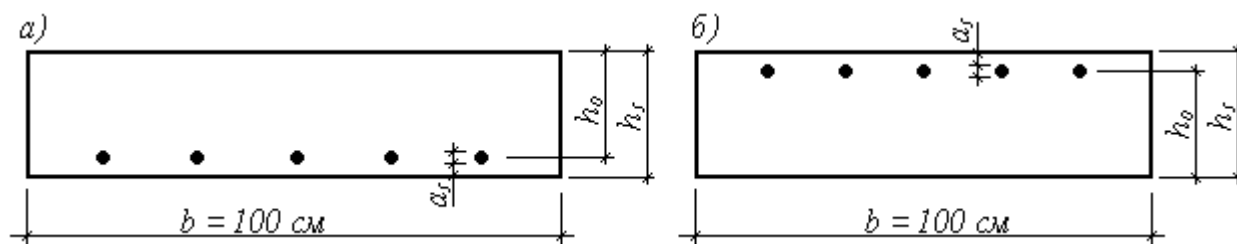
Розрахункові перерізи плити: а) на опори; б) в прольоті
